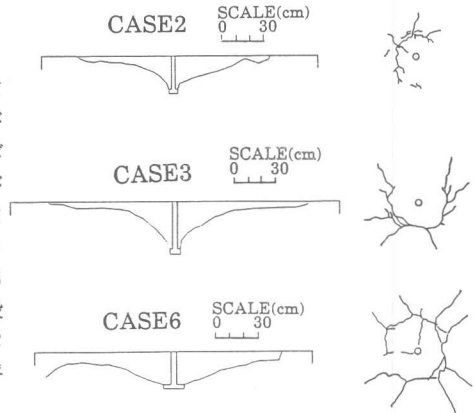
コンクリート表面のひび割れとコーン状破壊の断面形状
